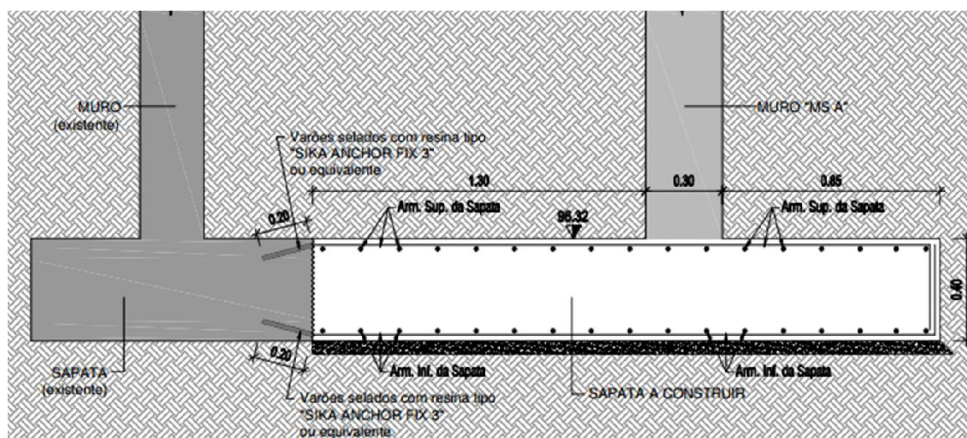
Pormenor da ligação das sapatas (Marques, 2011).
